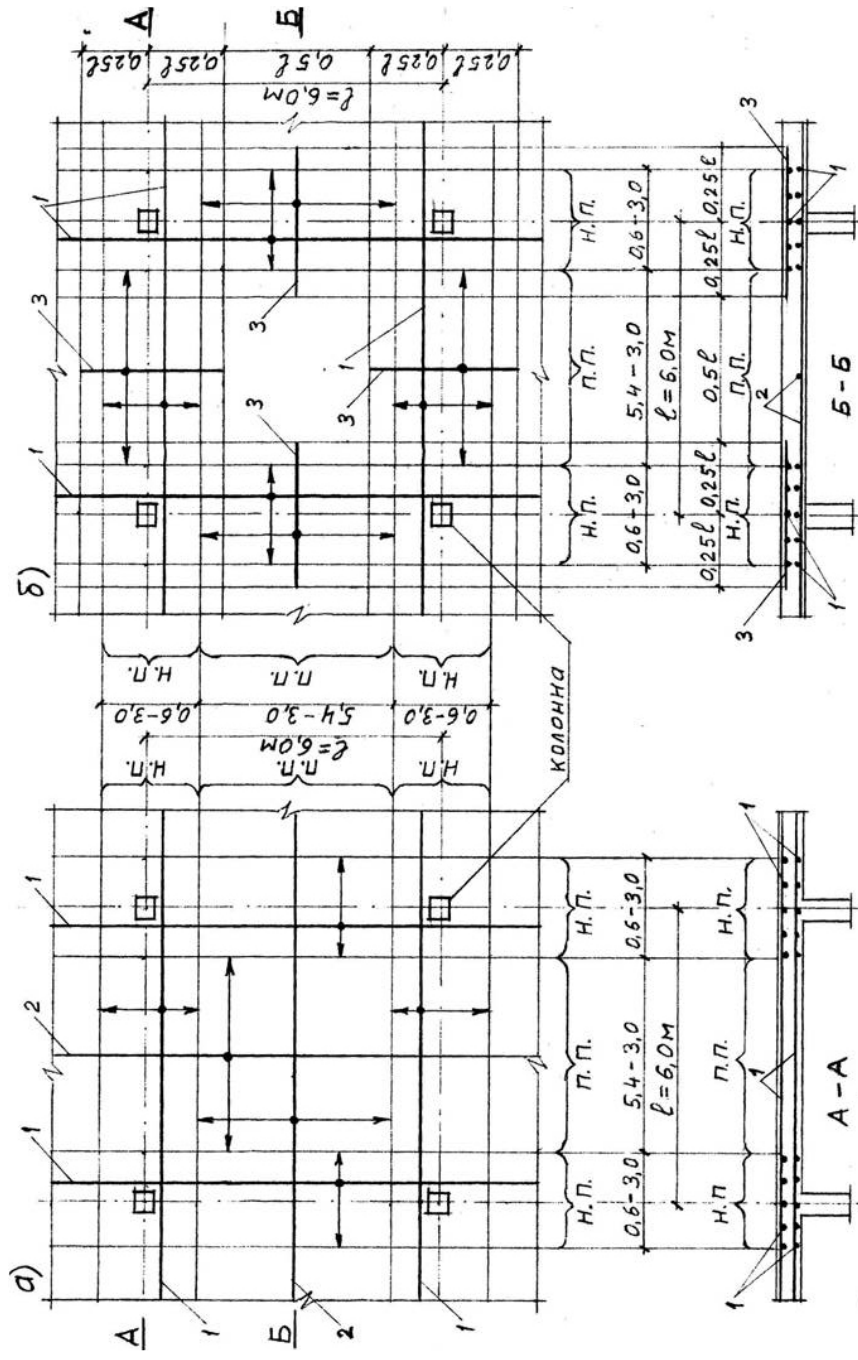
Армирование монолитного безбалочного бескапитального перекрытия:
